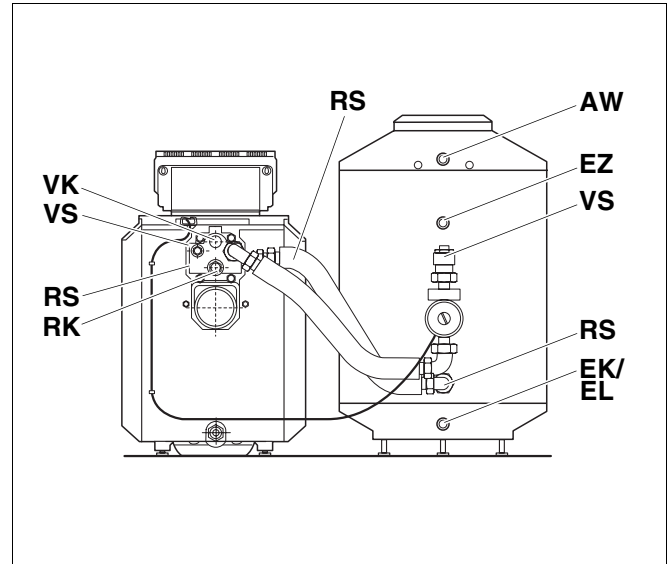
Hydraulische Anschlüsse (Rückansicht)
